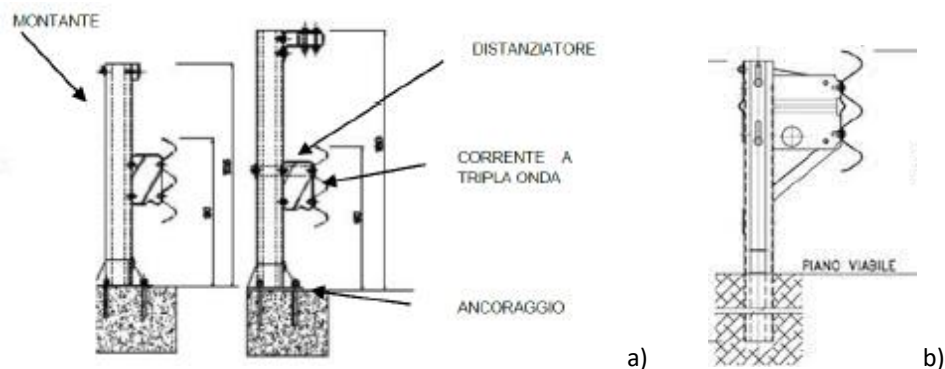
Guardrail: a) ancorato su cordolo in c.a. b) infisso nel terreno
